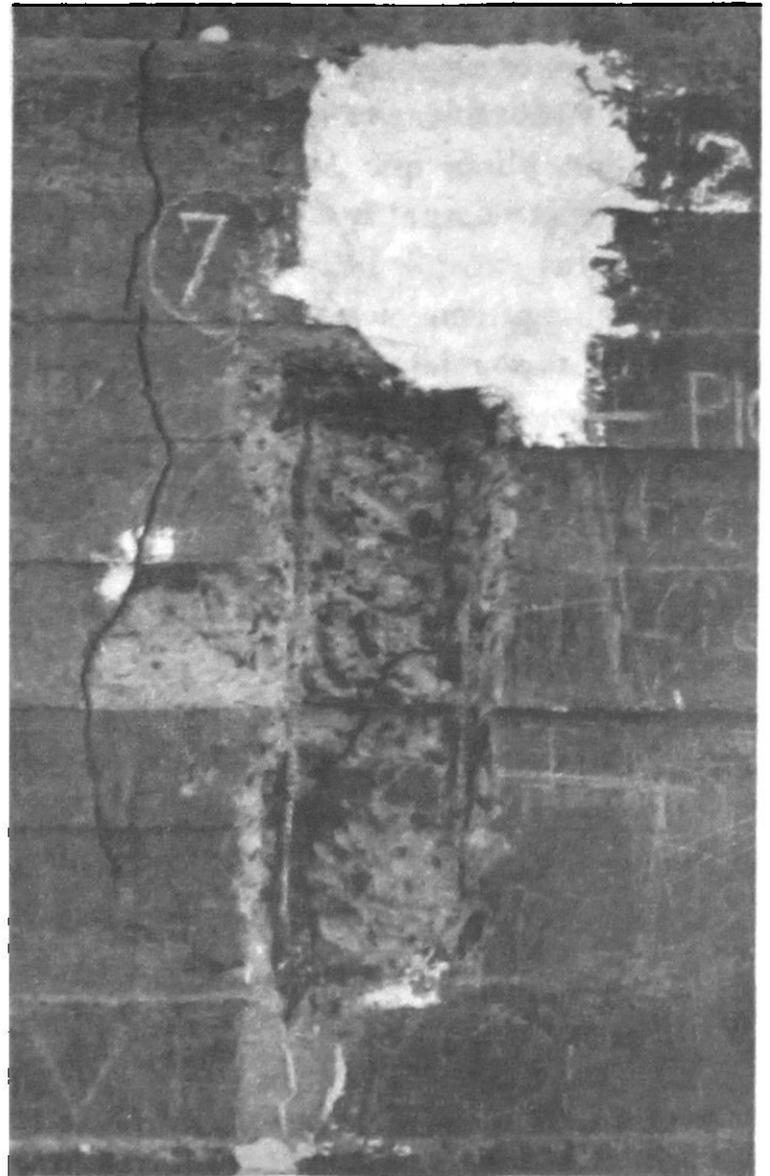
Vista de grieta estructural en el muro frontal del estribo sur; a la izquierda de la foto y en la zona picada al centro. Grieta remarcada para visualizarla mejor.
